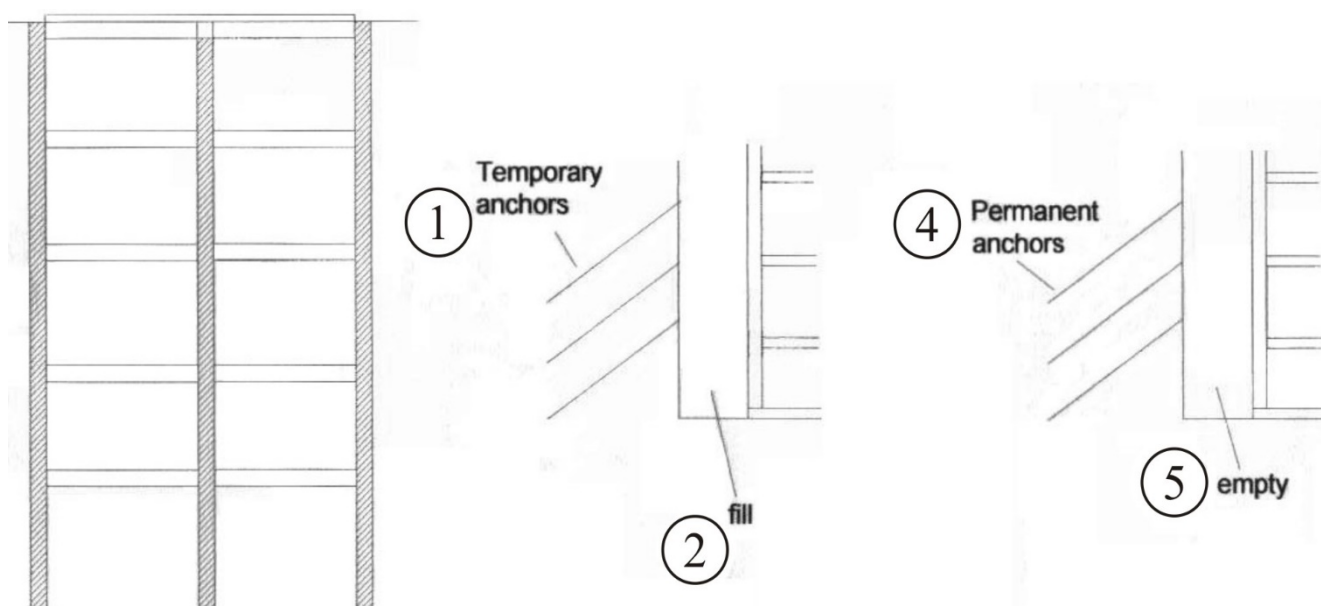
Строительство сверху вниз (под защитой перекрывающей стены)
